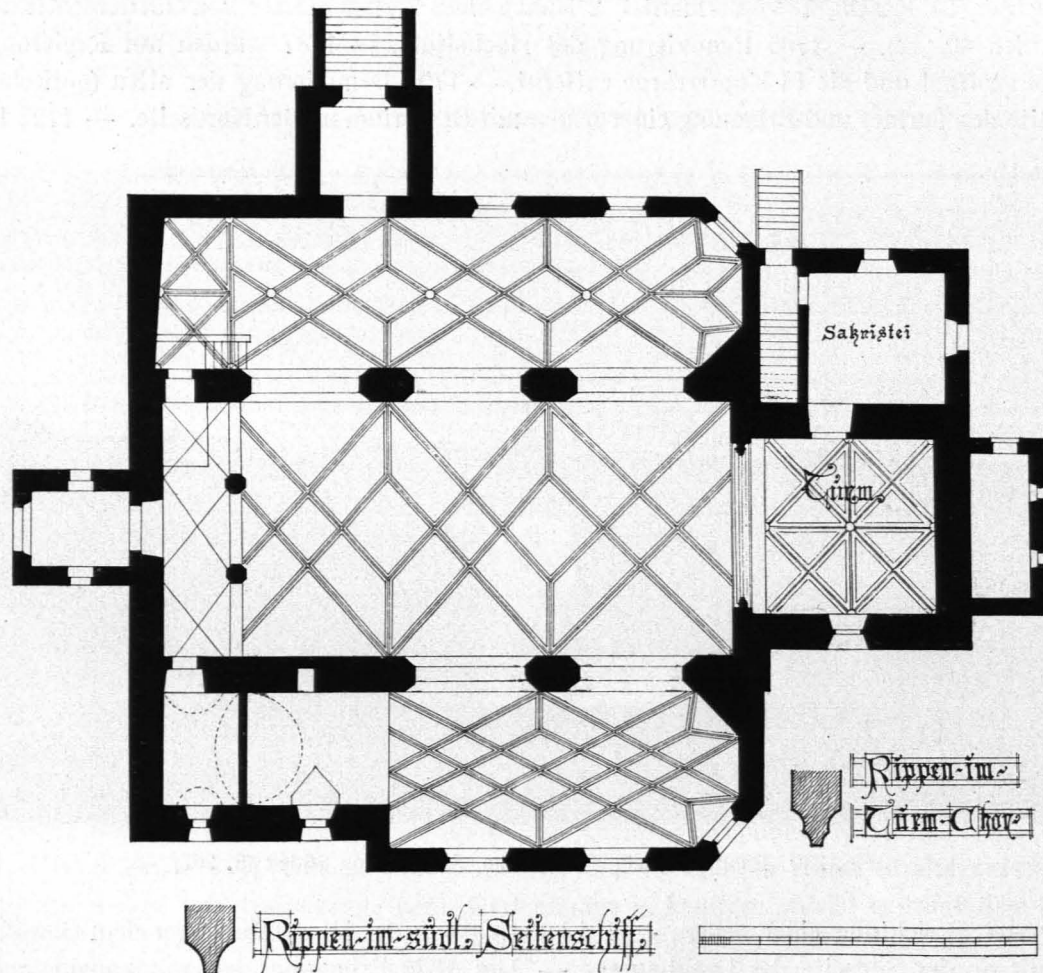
Rappottenstein, Pfarrkirche, Grundriß 1 : 250 (S. 268)
